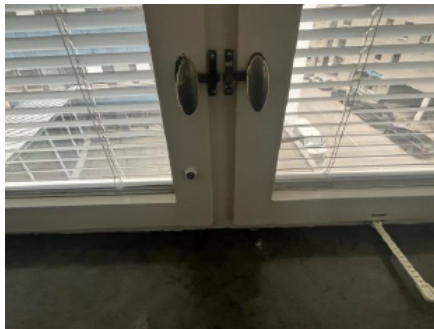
och 11. Ursprungliga träfönster med beslag samt fönsterbänkar av mörk sten är bevarade. Rester av ursprunglig planlösning med arkivrum/våtrumsgupper med rundade hörn finns bevarad på plan 4.
